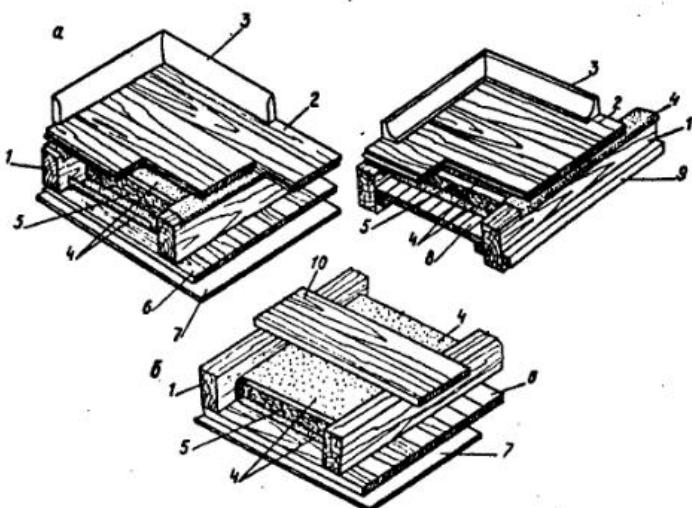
Перекрытия: а — междуэтажное (два варианта); б — чердачное. 1 — балки; 2 — доски пола; 3 — плинтус; 4 — пергамин; 5 — утеплитель (минераловатные плиты); 6 — ДВП; 7 — настил из необрезных досок; 8 — подшивки ДВП; подшивка потолка отделочной доской; 9 — черенной (крепежный) бруск; 10 — ходовая доска.
